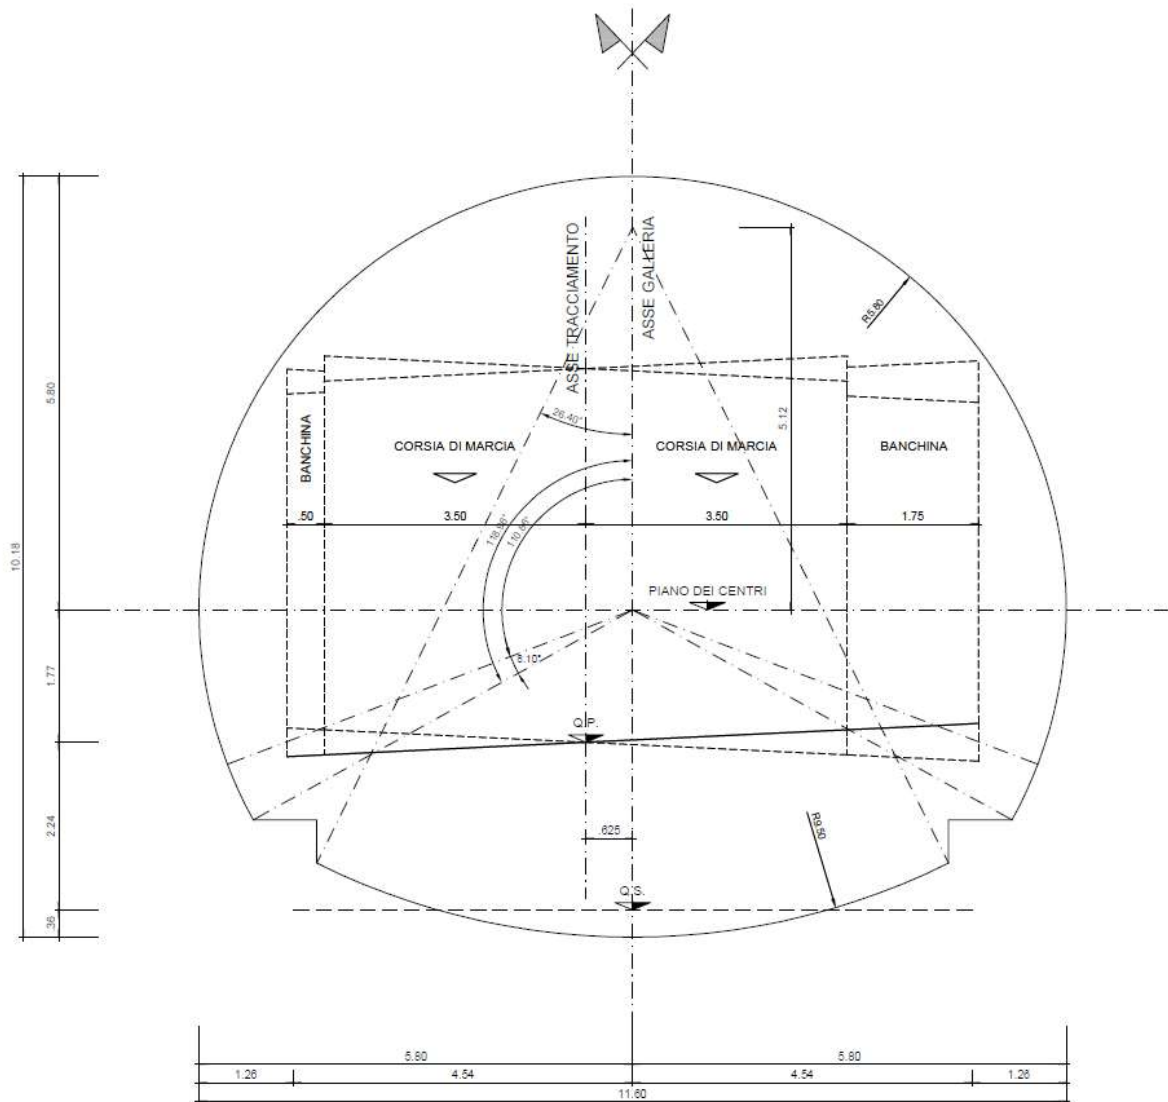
Sezione tipo funzionale galleria Picchiarella.
